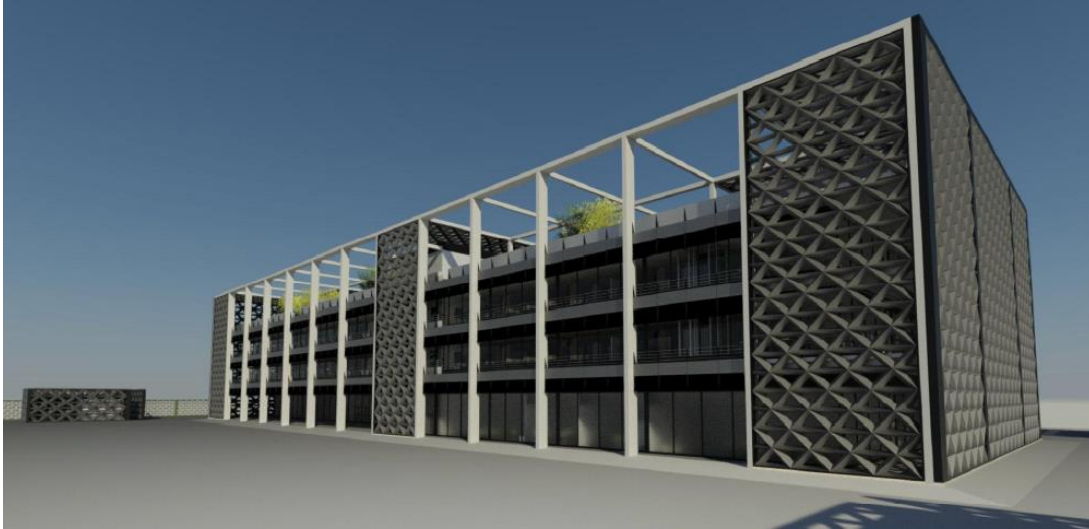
Vista 3D de un modelo BIM cortesía de CREA Soluciones Inteligentes (BuildingSMART, 2020).
